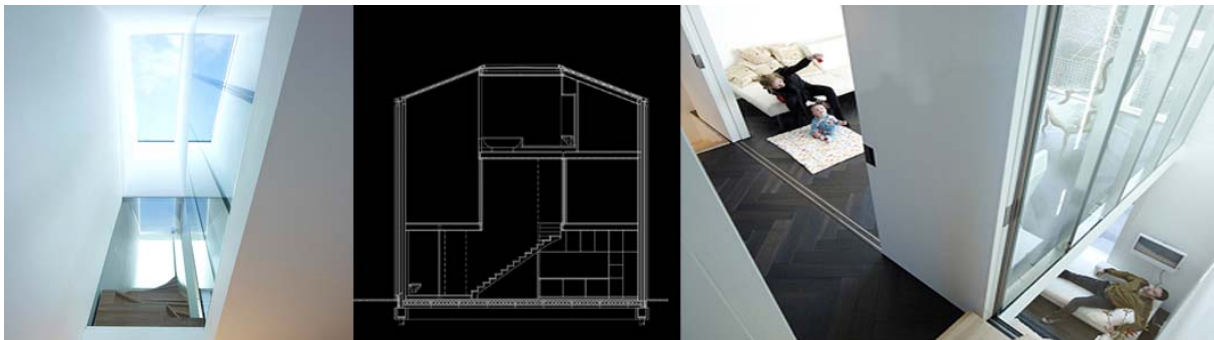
Light House, Amsterdam (Arch. Bordin, NL), Innenraumdarstellungen und Gebäudeschnitt
